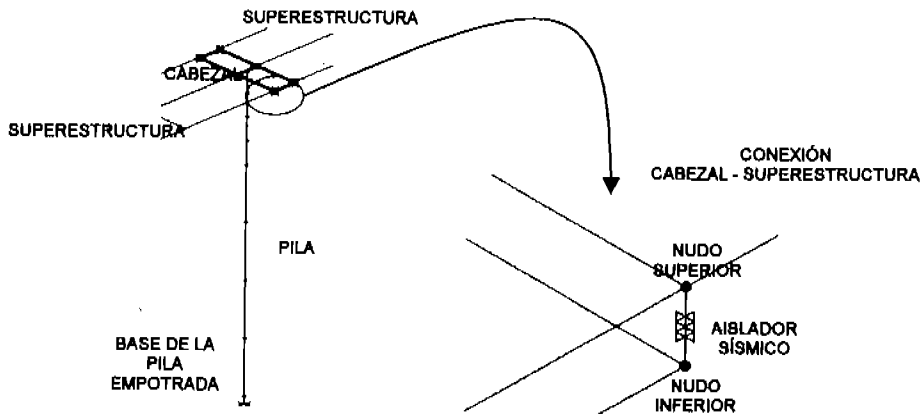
Detalle de la conexión del cabezal con la superestructura.
